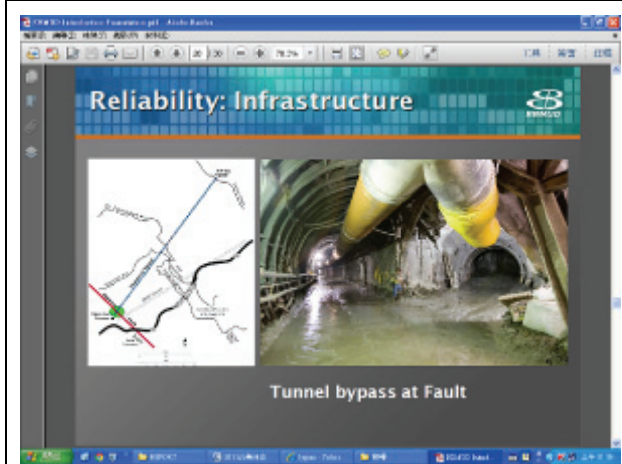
過斷層原水隧道旁通管 Bypass
